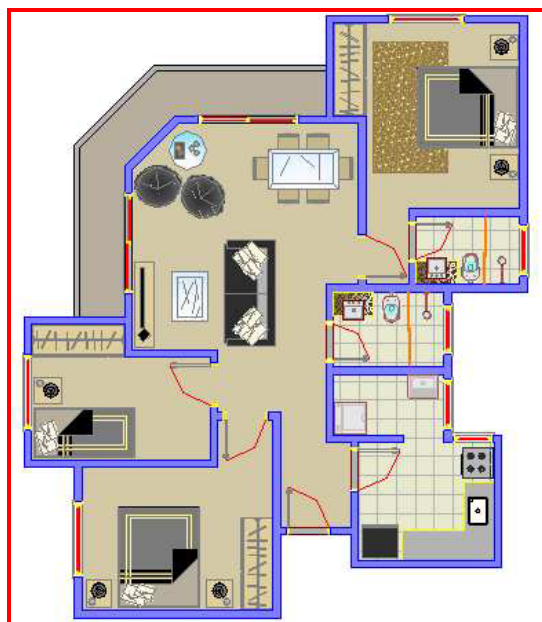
Layout do apartamento modelo com 81,08 m2, sem escala.
